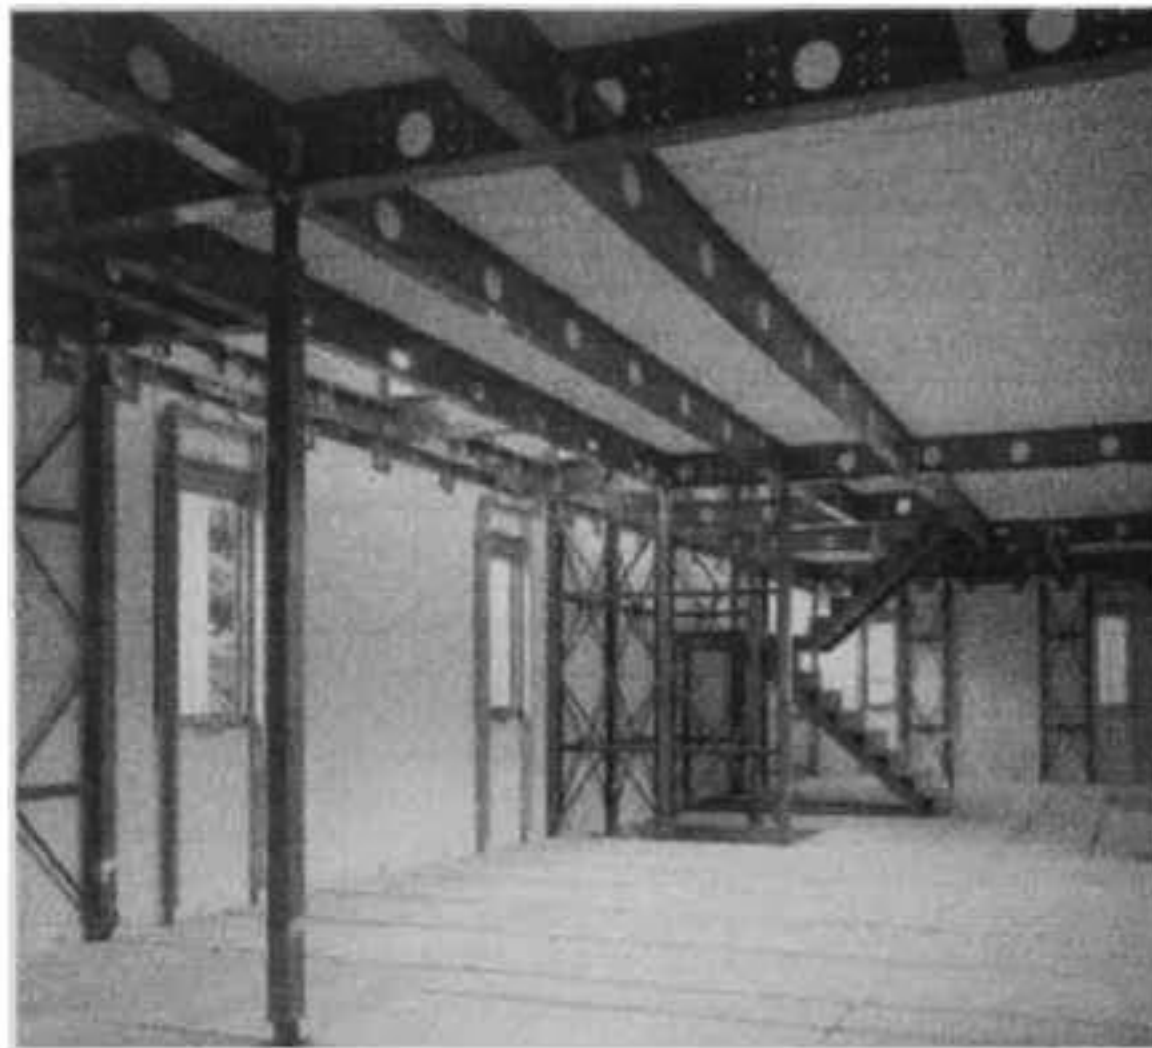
Simulando el proceso de construcción. Las paredes sándwich colocadas forran la estructura del edificio.
